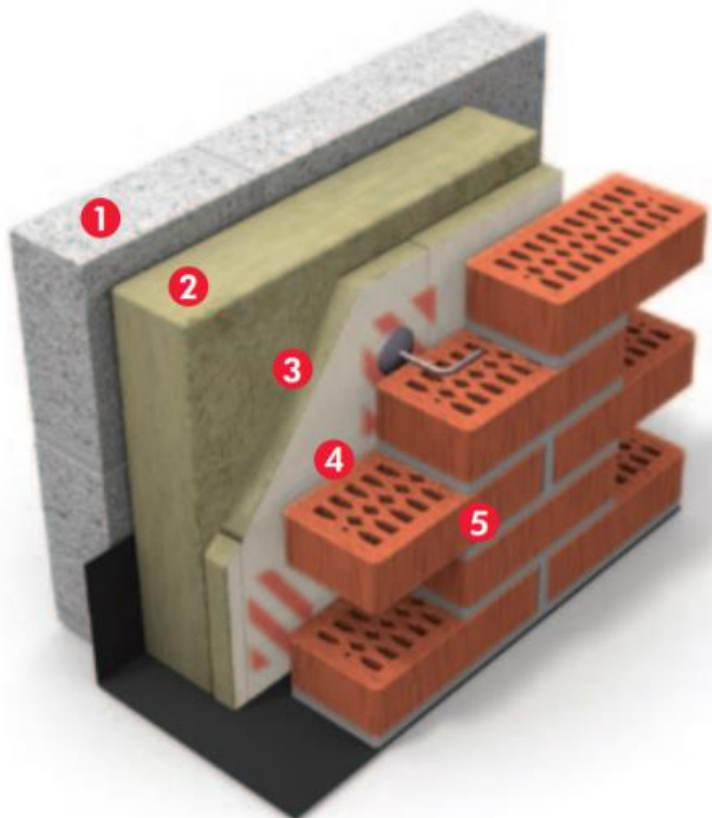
Exempelbild på en platsmurad tegelvägg. 1) inre skal 2) isoleringsskivor 3) vindskyddsisolering 4) sammanhängande luftspalt 5) fasadtegel
